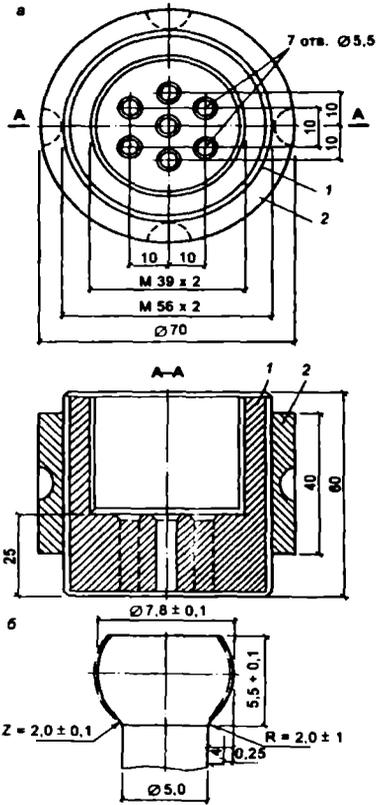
Анкерное устройство для проволочной арматуры с высаженными головками:
